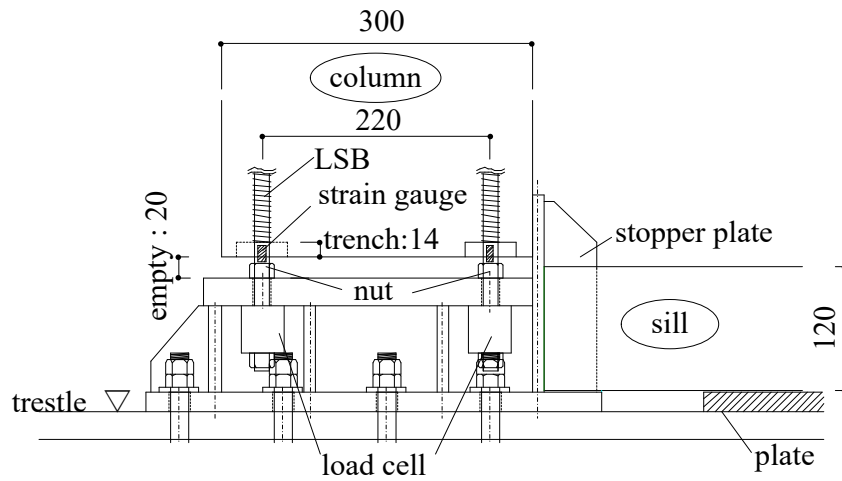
柱脚の詳細 (Basement of detailed view)
